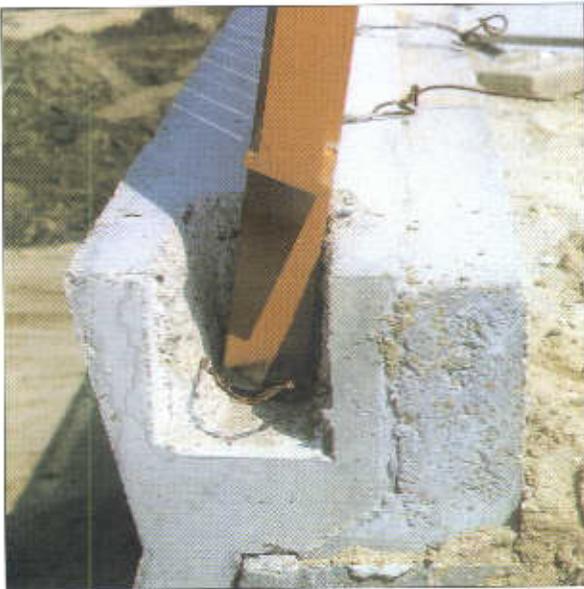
La profondeur de la réservation ne correspondait pas à celle portée sur les plans mis à la disposition du serrurier : il a fallu découper au chalumeau tous les supports de ce garde-corps.
